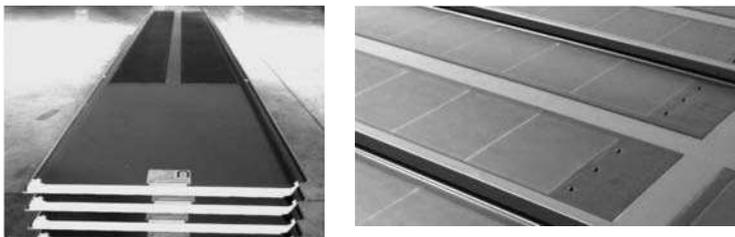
Dach-Sandwichelement mit zwei Randrippen und dazwischen auflaminiertem Dünnschicht-Solarmodul
